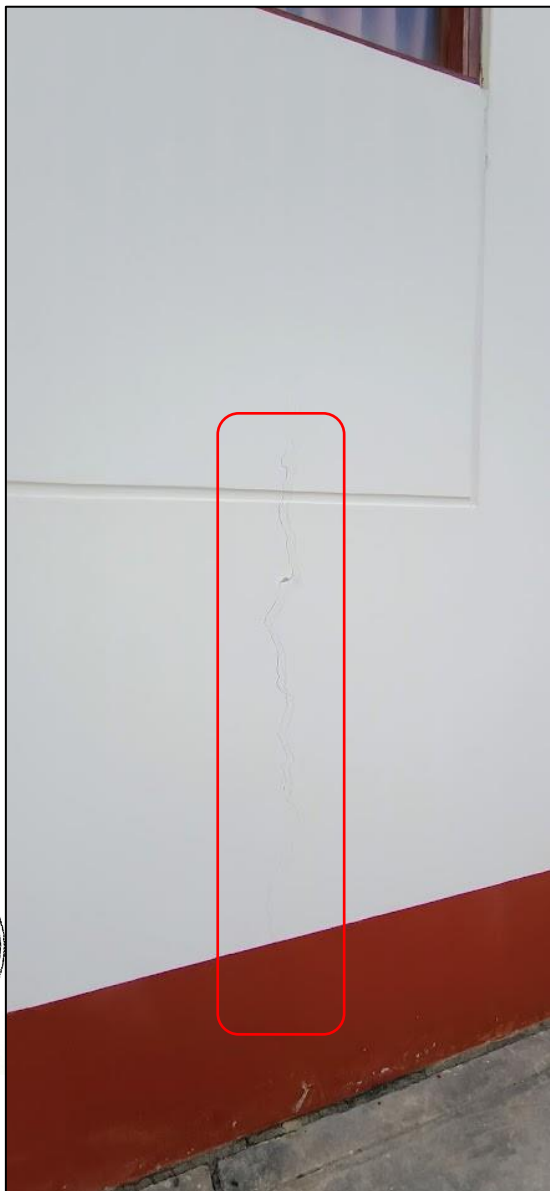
Vista de fisura vertical en muro de fachada norte.
